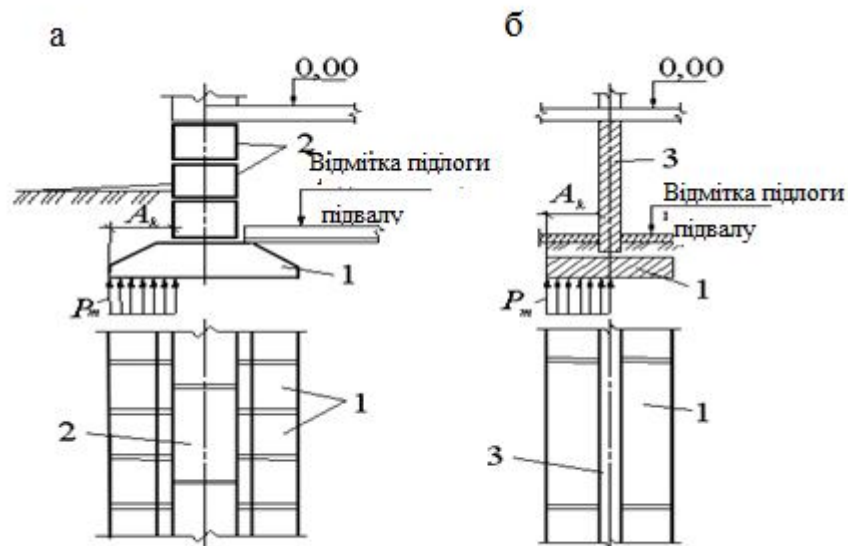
Збірні стрічкові фундаменти: *а* – для цегляних і блокових стін; *б* – для крупнопанельних стін; 1 – фундаментні плити; 2 – стінові фундаментні блоки; 3 – стінові панелі підвалу
